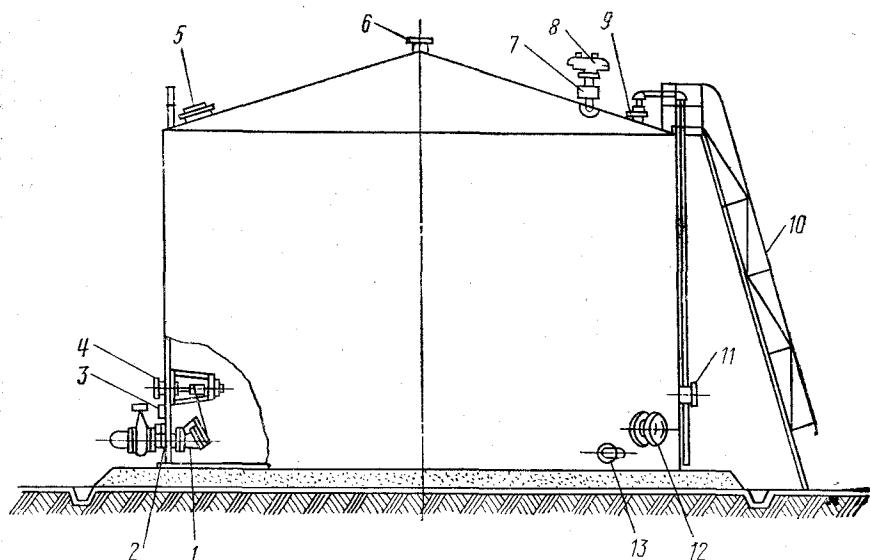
Схема расположения оборудования на резервуарах для нефти и светлых нефтепродуктов:
